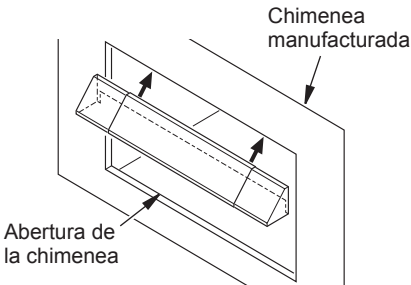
Instalación de la cubierta en el interior de una chimenea manufacturada
